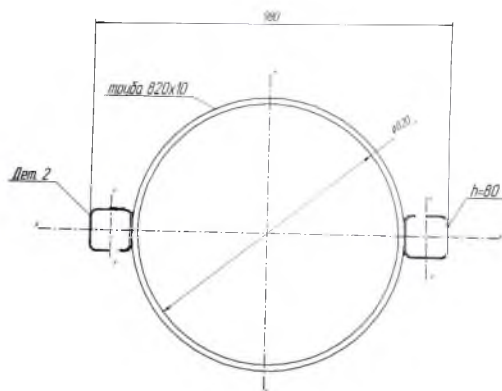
Профиль стального шпунта трубчатого сечения ШТН повышенной несущей способности / Steel heavy-duty sheet piling profile ШТН
